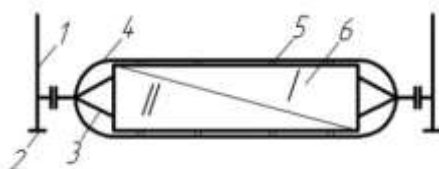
Планова схема залізобетонного двосекційного захищеного оголовка з розвиненою водоприймальною частиною: 1 – самопливні водоводи; 2 – заглушки (для можливості очищення ліній); 3 – розтруби; 4 – залізобетонний корпус оголовка; 5 – вікна (панелі) з решітками; 6 – камери-секції
